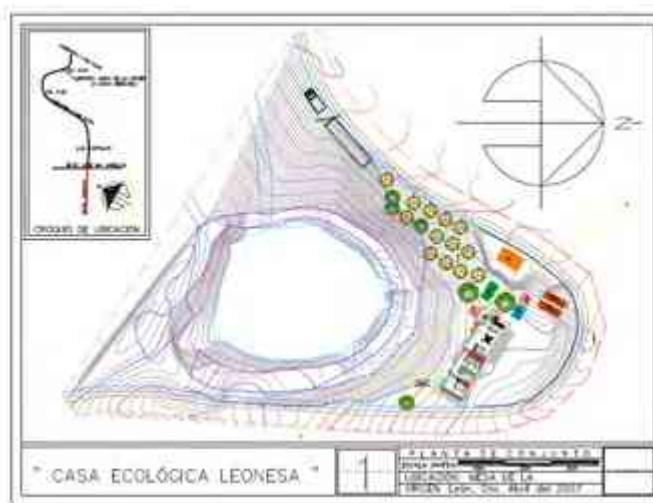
Planta De Conjunto De La Casa Ecológica Leonesa.
